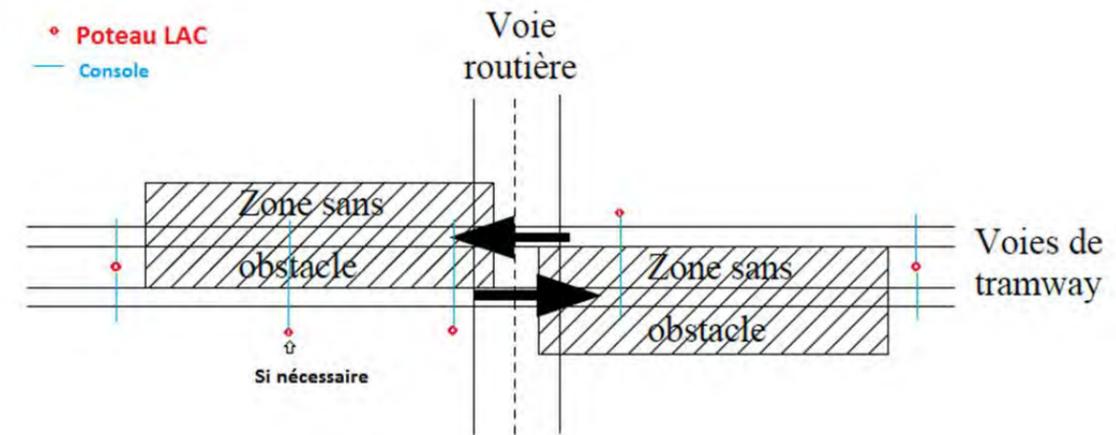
Exemple de positionnement des poteaux LAC aux intersections
